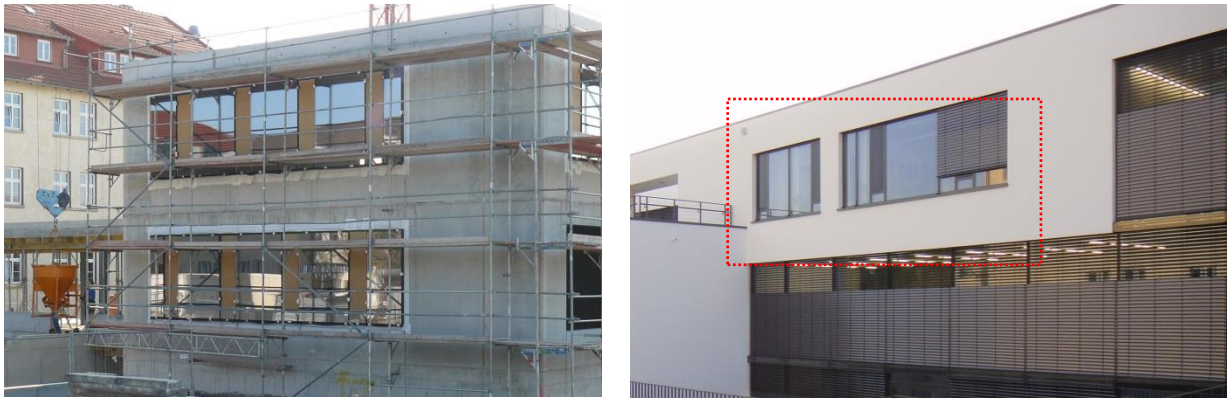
links: Holzfassade nach dem Einbau (außen Planungslabor EG und OG)
